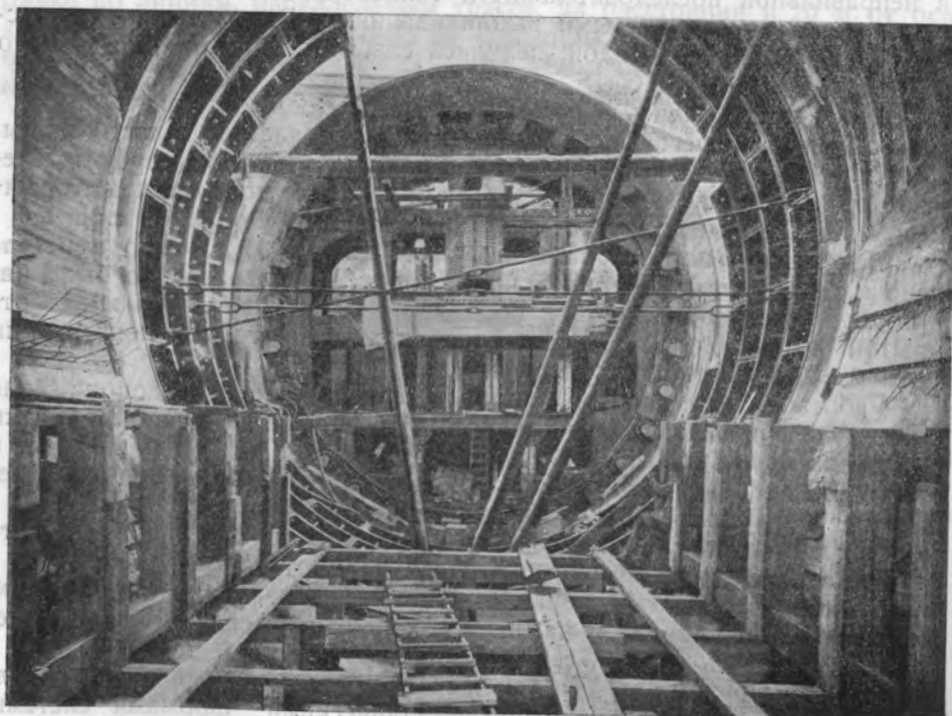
Монтаж щита для проходки Шельдского тоннеля в открытом котловане.
